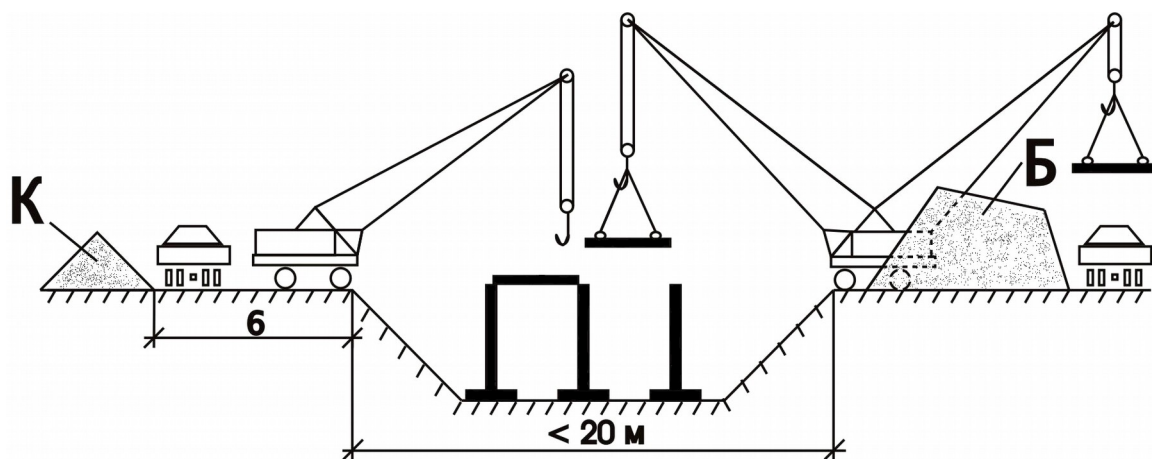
Организация работ в котловане с перемещением технических средств за пределами котлована
